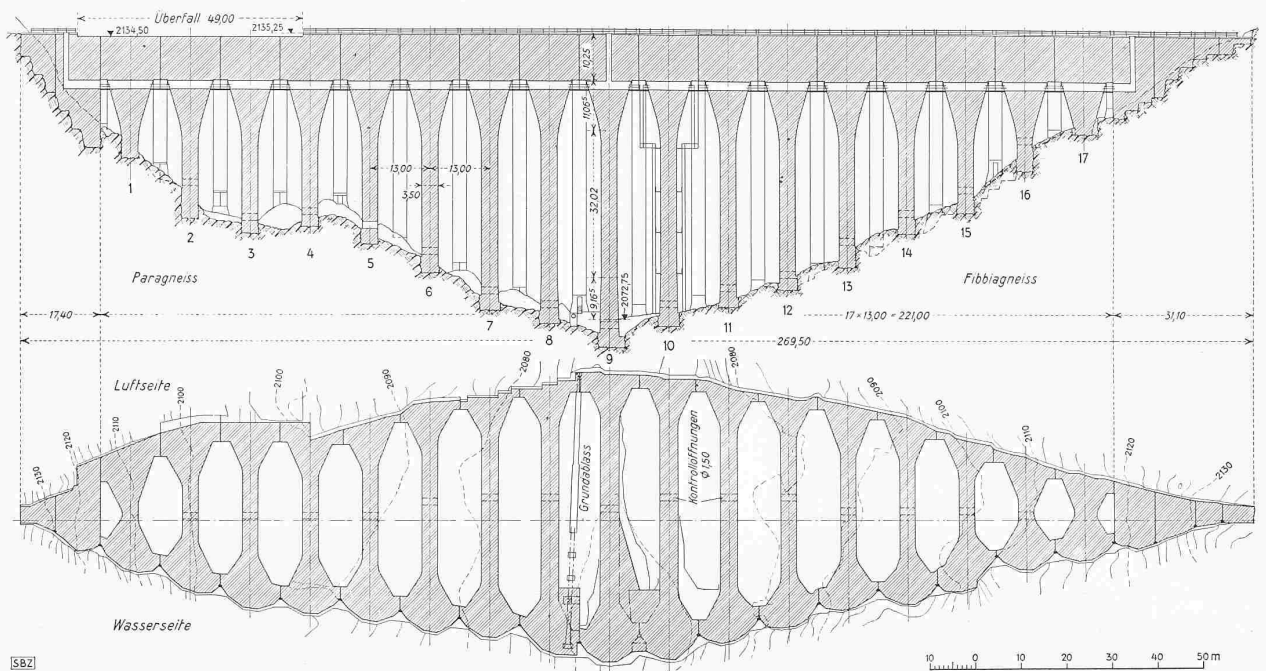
Staumauer Lucendro. Längsschnitt und Grundriss. Masstab 1:1500. Text Seite 52
